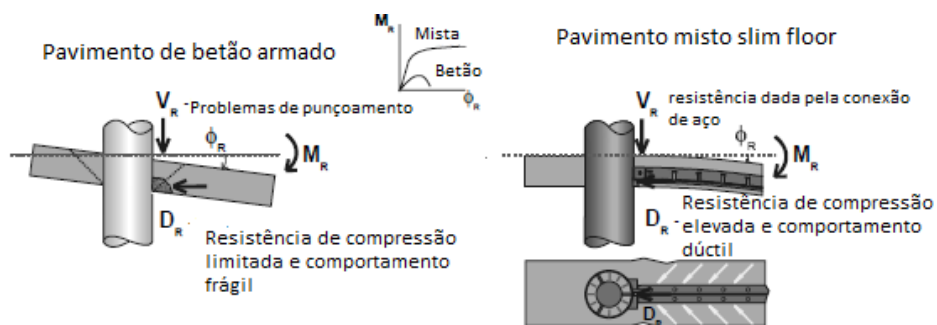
Resistência da ligação laje-pilar, comparação do pavimento *slim floor* com um pavimento de betão [16].
